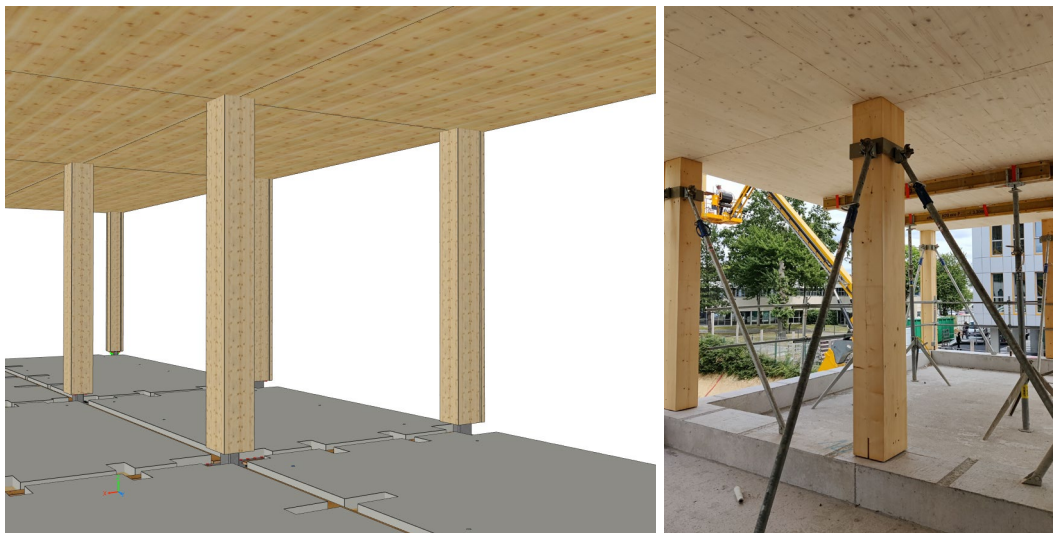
HOBOA, un système poteaux-plancher. Pour le bâtiment Canopia Business, 4 planchers portent sur un poteau. On économise de la matière bois par rapport à une configuration en appui avec poutre.
